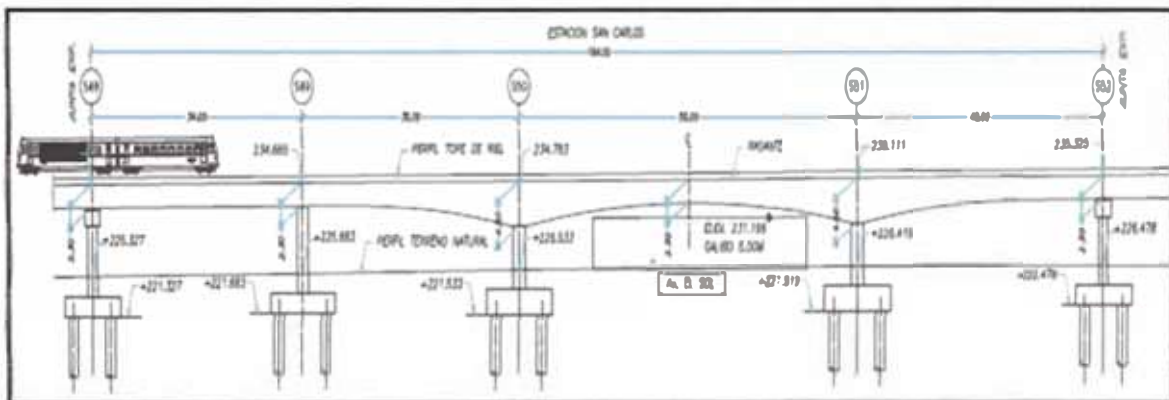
Viaducto elevado Tren Eléctrico – Vista General del Módulo MS12
